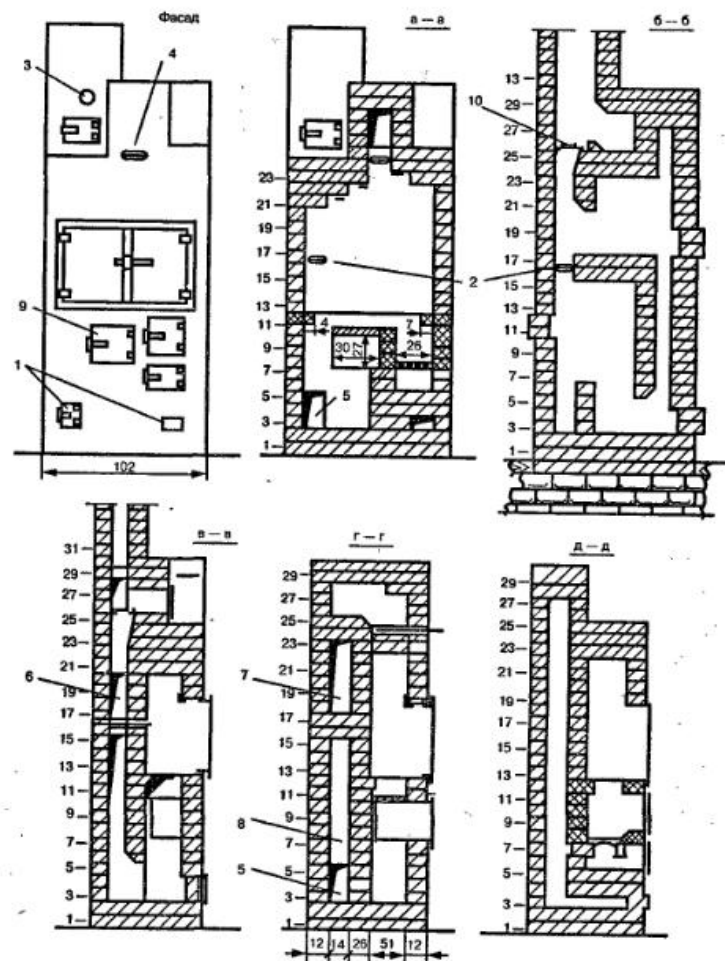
Разрезы отопительно-варочной печи ИП-2 (с духовкой).
